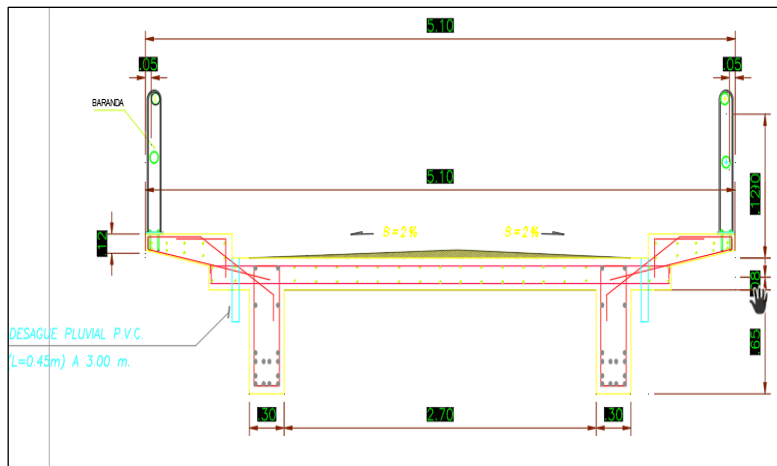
Modelo Geométrico planteado Dibujo CAD
